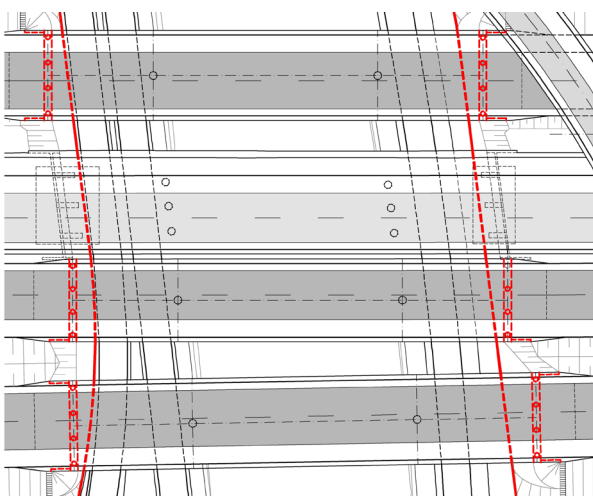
Propuesta alternativa para las estructuras E-10, E-11 y E-12. Planta
